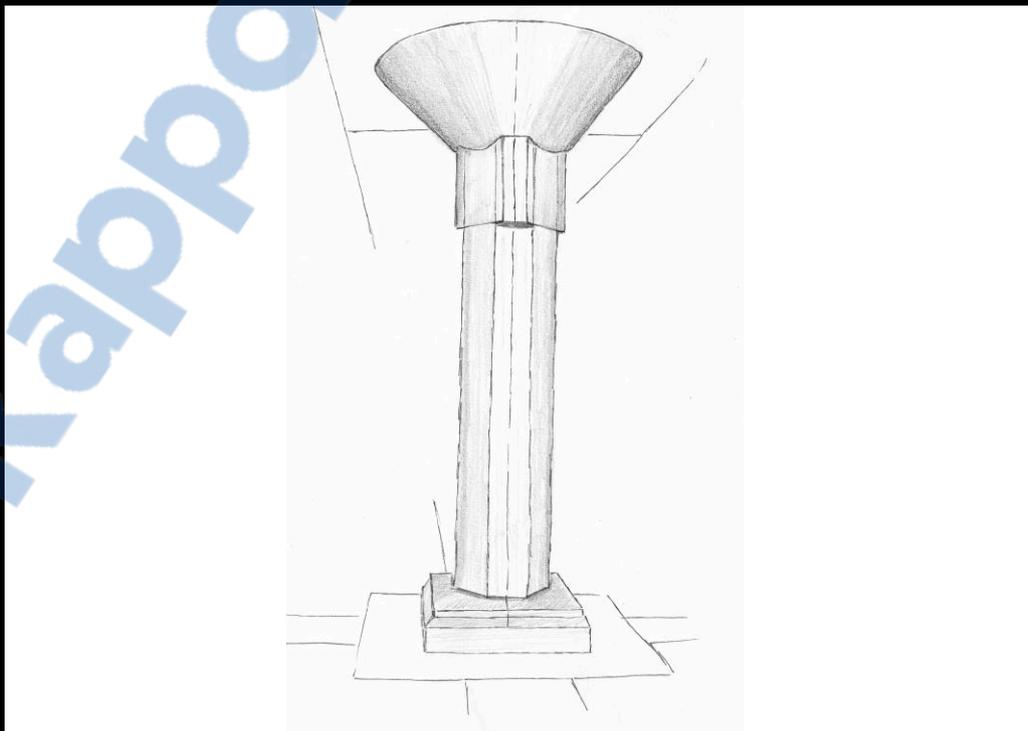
Croquis d'une colonne type en béton constituant le système constructif principal du complexe.
